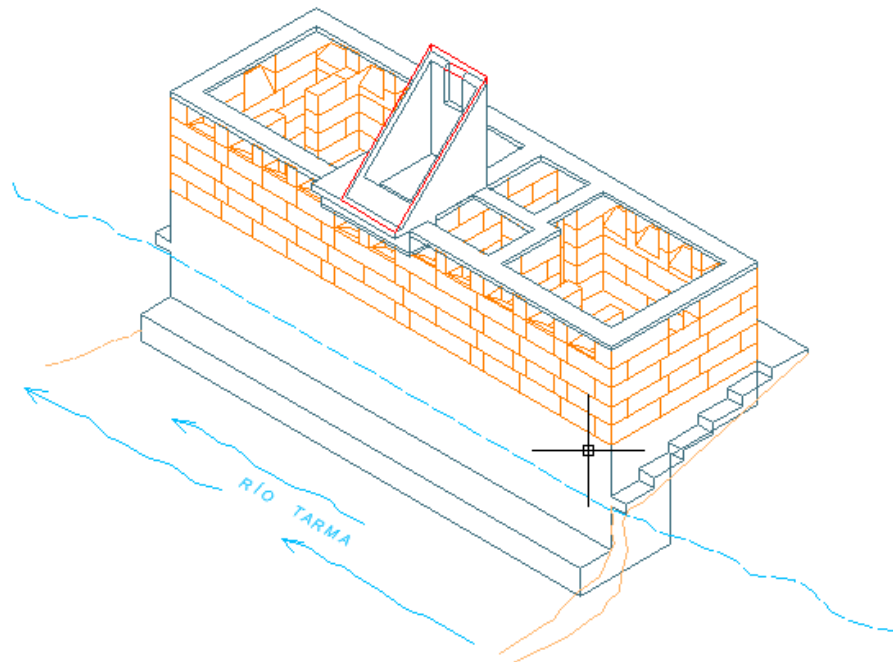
Vaceado de fondos y muros del tanque elevado y el techo de losa macisa del cuarto de servicio (VTE=4.00m³, VLM=1.00m³), encofrado del techo inclinado de losa maciza del tanque elevado (A=8.00m²).
